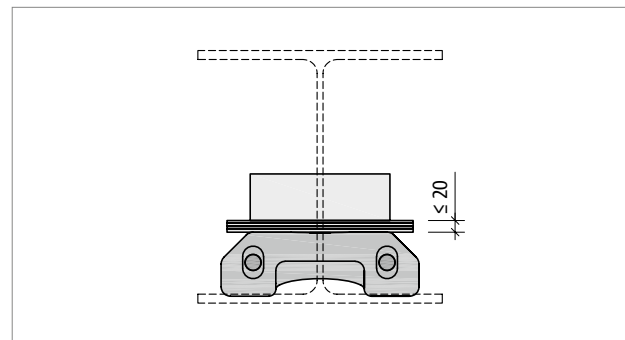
Schöck Isokorb® RT Typ SQ: Distanzplättchen auf der Lastaufnahmeplatte erhöhen die Lage des Stahlträgers um bis zu 20 mm
